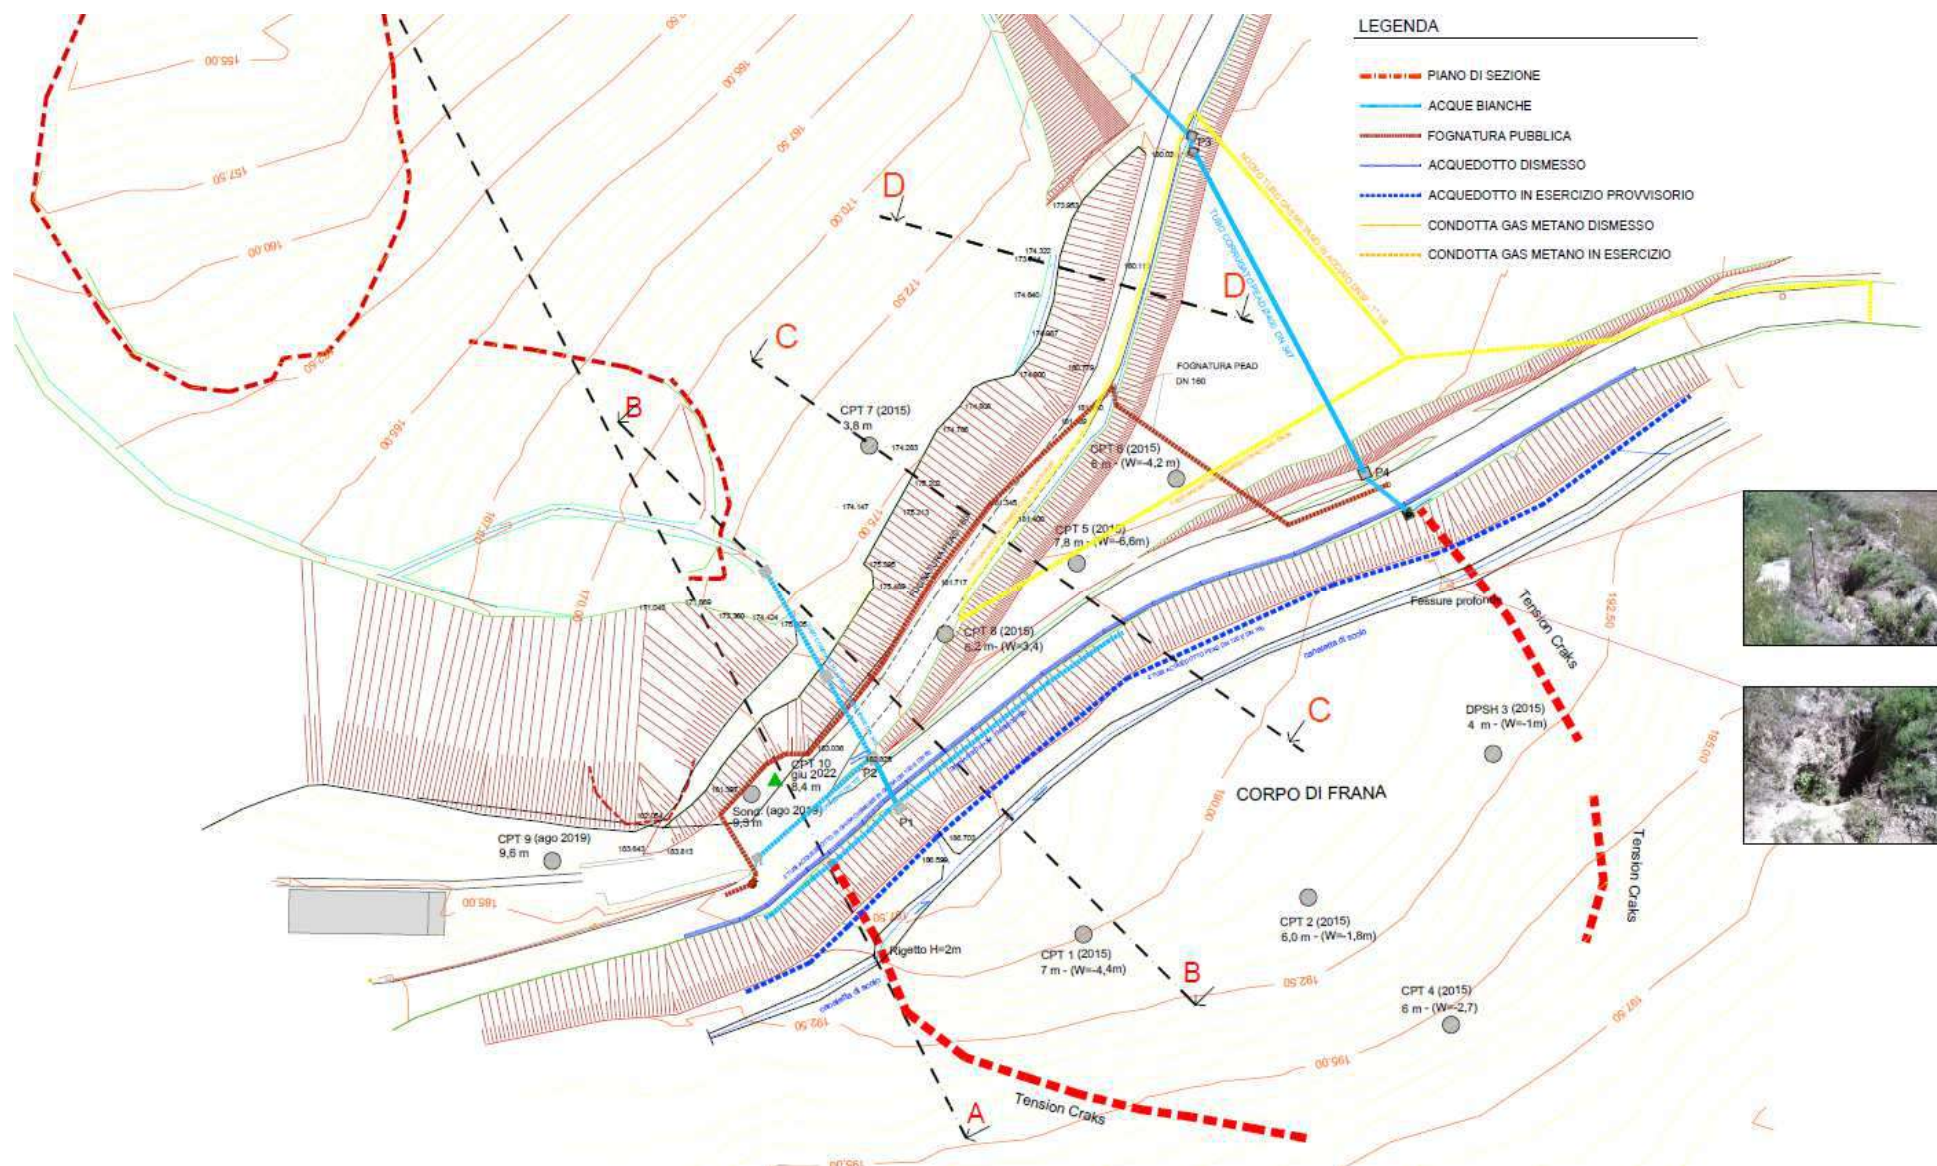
Planimetria generale con rilievo delle reti e ubicazione delle prove in sito CPT e del sondaggio (Tav. A2-b)
